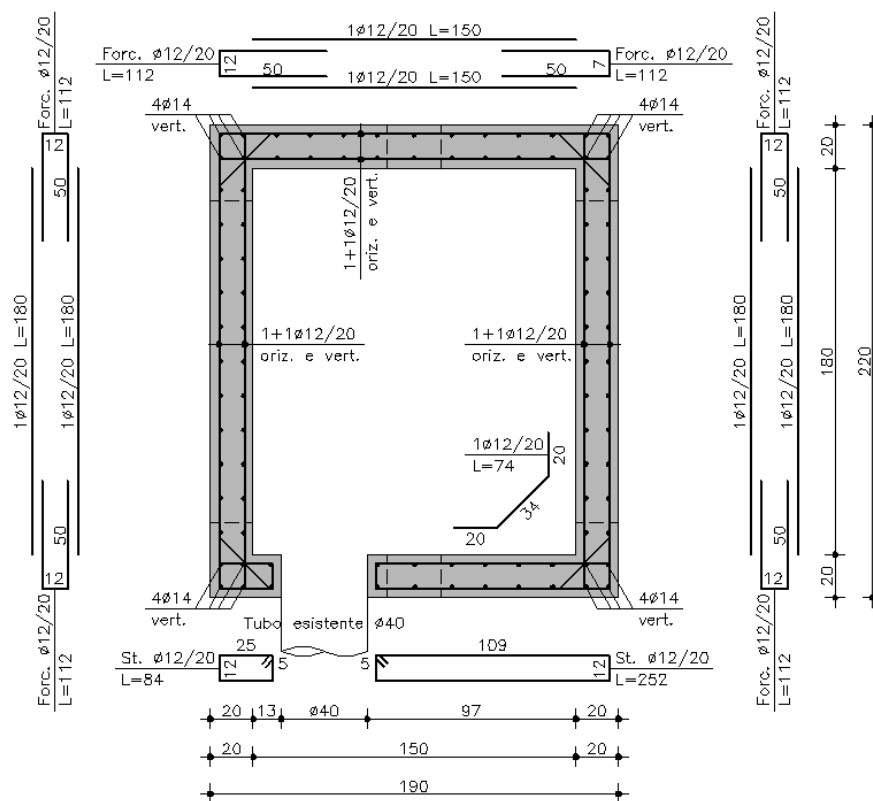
Pozzetto n. 6 - Sezione orizzontale D-D
